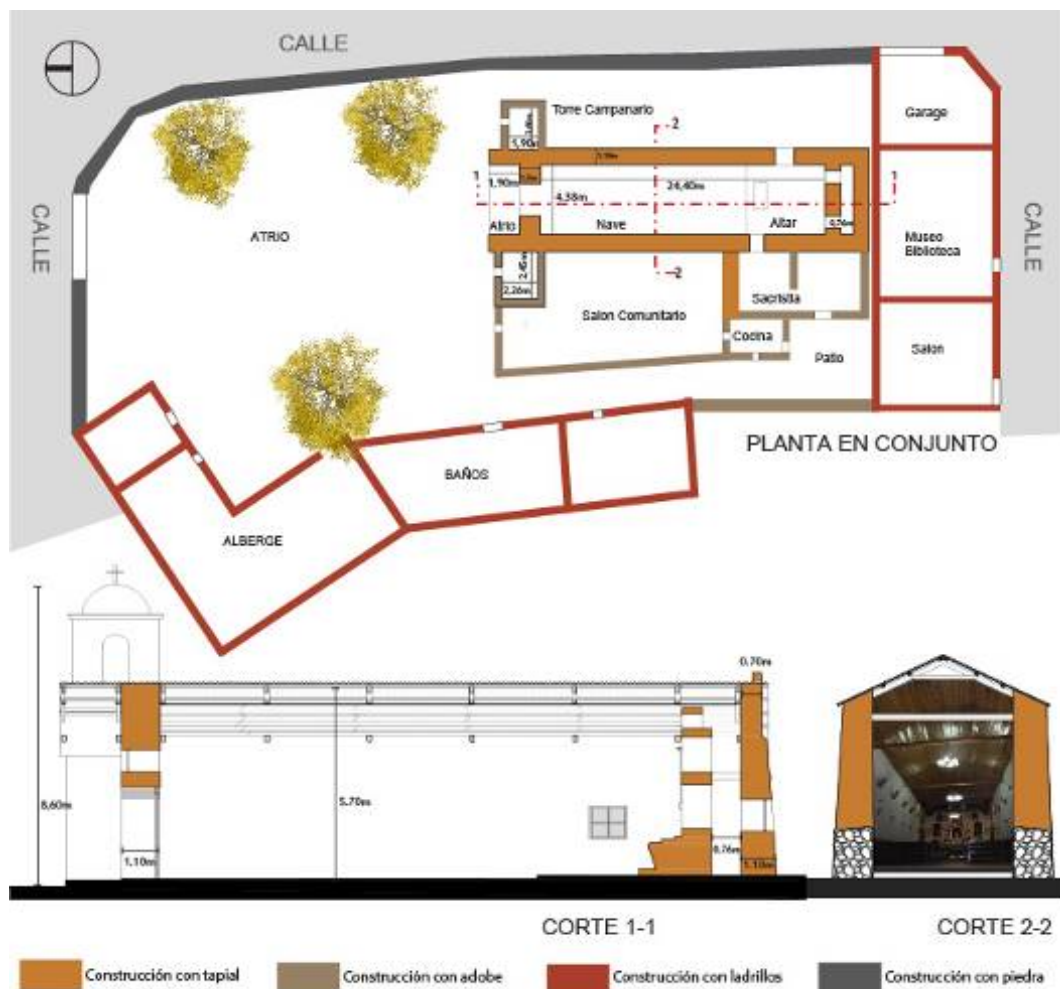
Planimetría del conjunto de la Iglesia de Nazareno (elaboración Dorado y Veliz)
